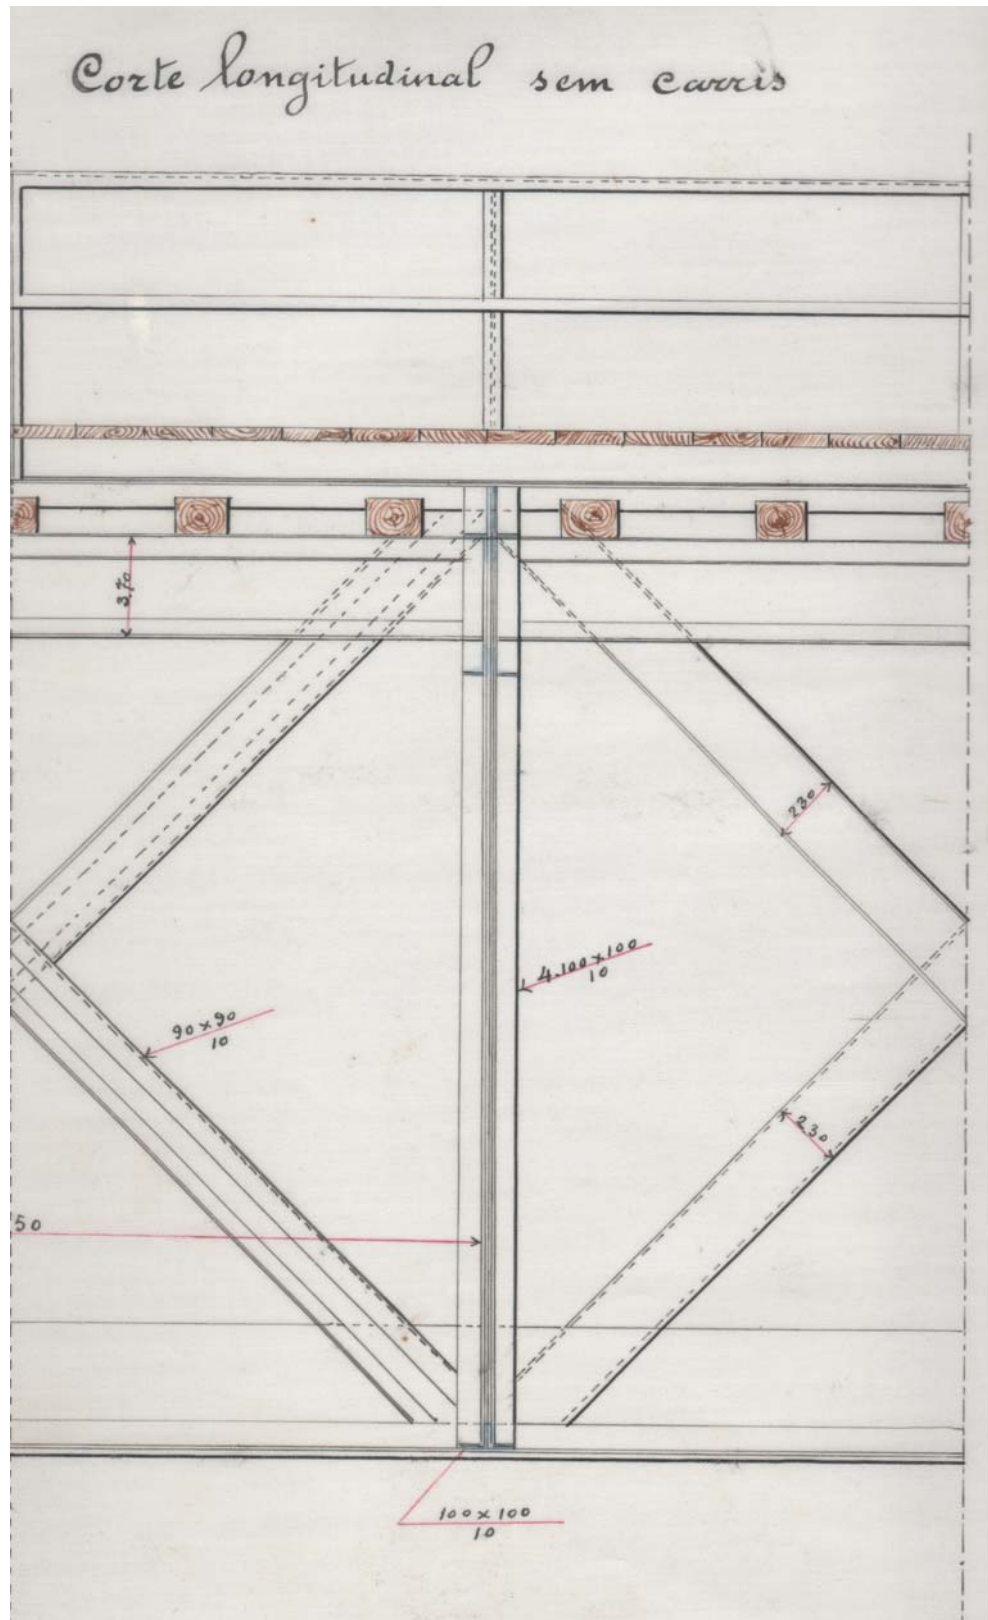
Ponte metálica com 35,0 m de vão – corte longitudinal (fonte: Arquivo Histórico do Instituto da Mobilidade e dos Transportes Terrestres)
